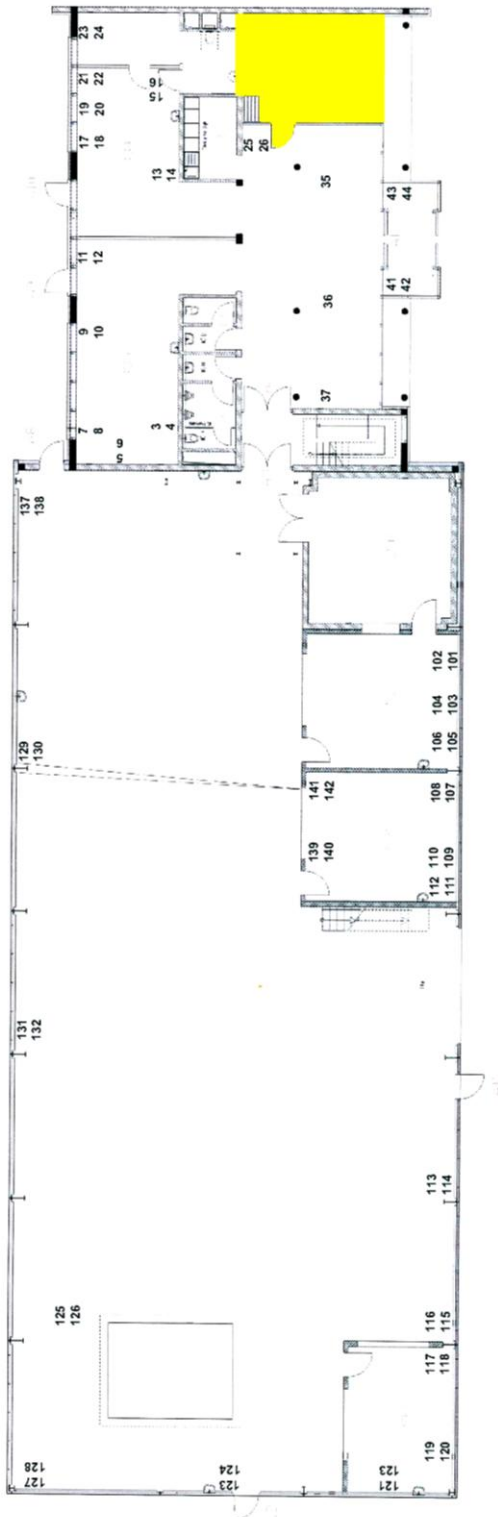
Grundriss SZMF-Nebengebäude Erdgeschoss
